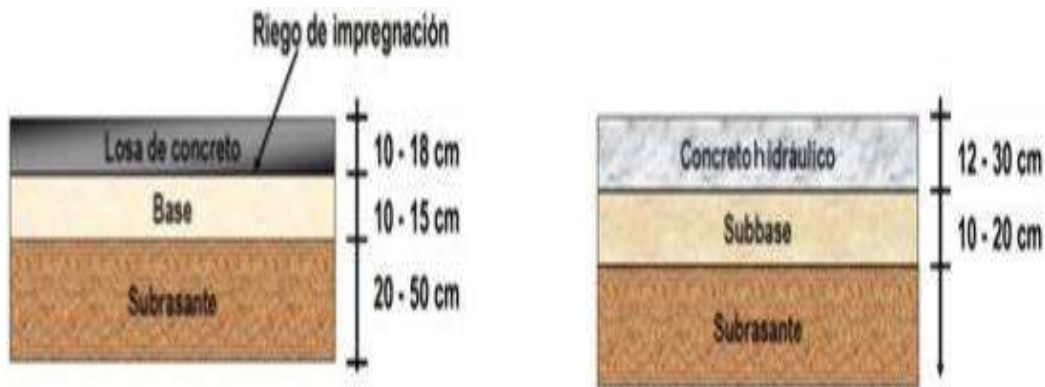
Pavimentos de concreto hidráulico o rígidos.
